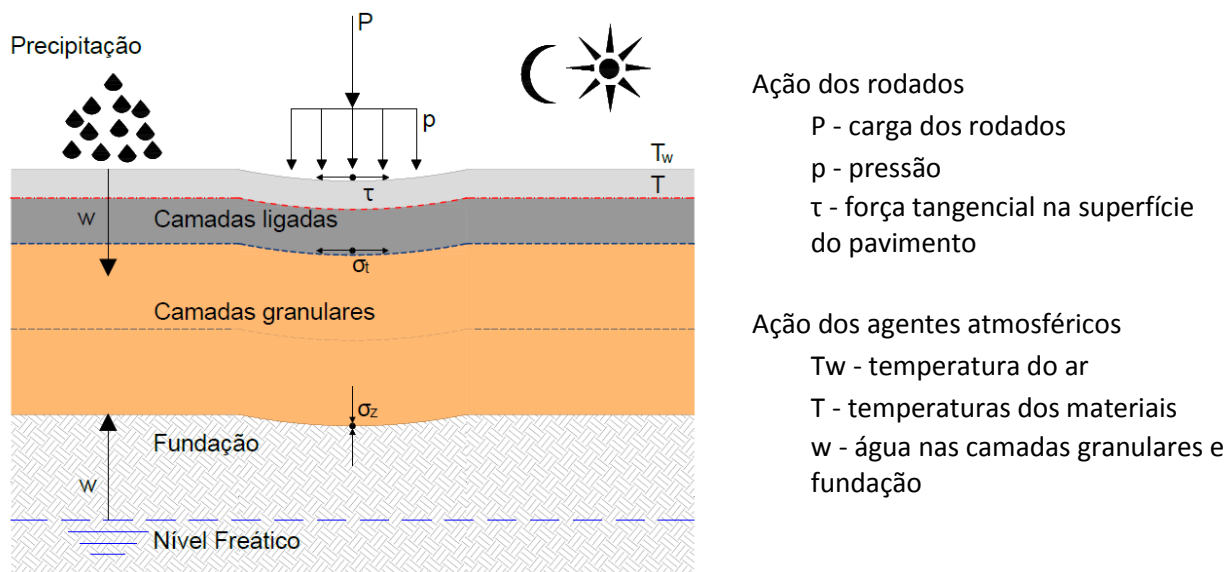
Pavimento rodoviário: constituição e ações a que está sujeito
